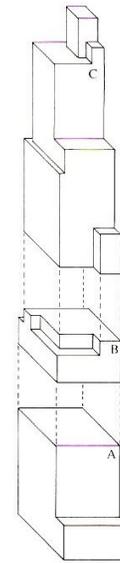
prospettiva e pianta - C. Price Company Tower
